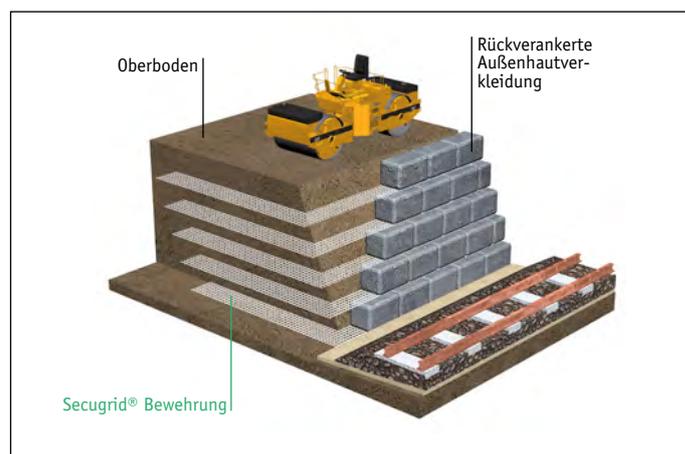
Bewehrte Stützkonstruktion bis 87° mit rückverankerter Außenhautverkleidung
